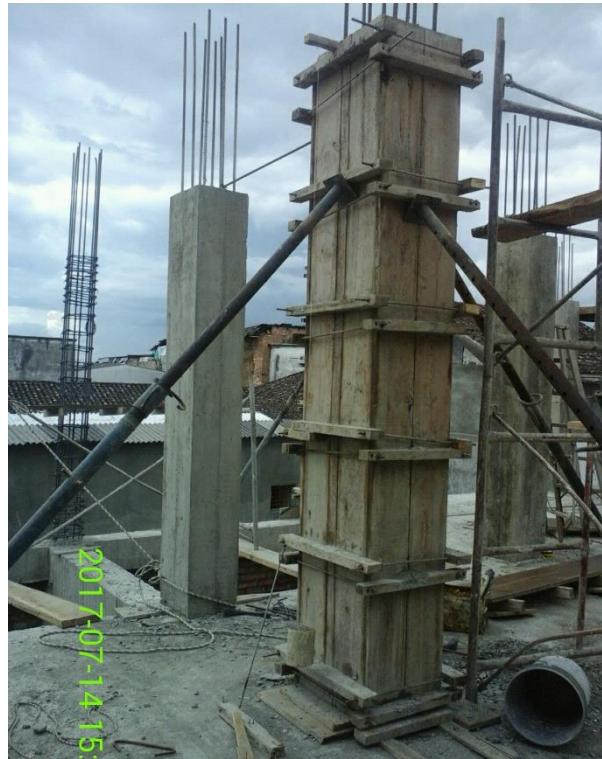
COLUMNAS C5 Y C3 NIVEL 3 BLOQUE 1.
